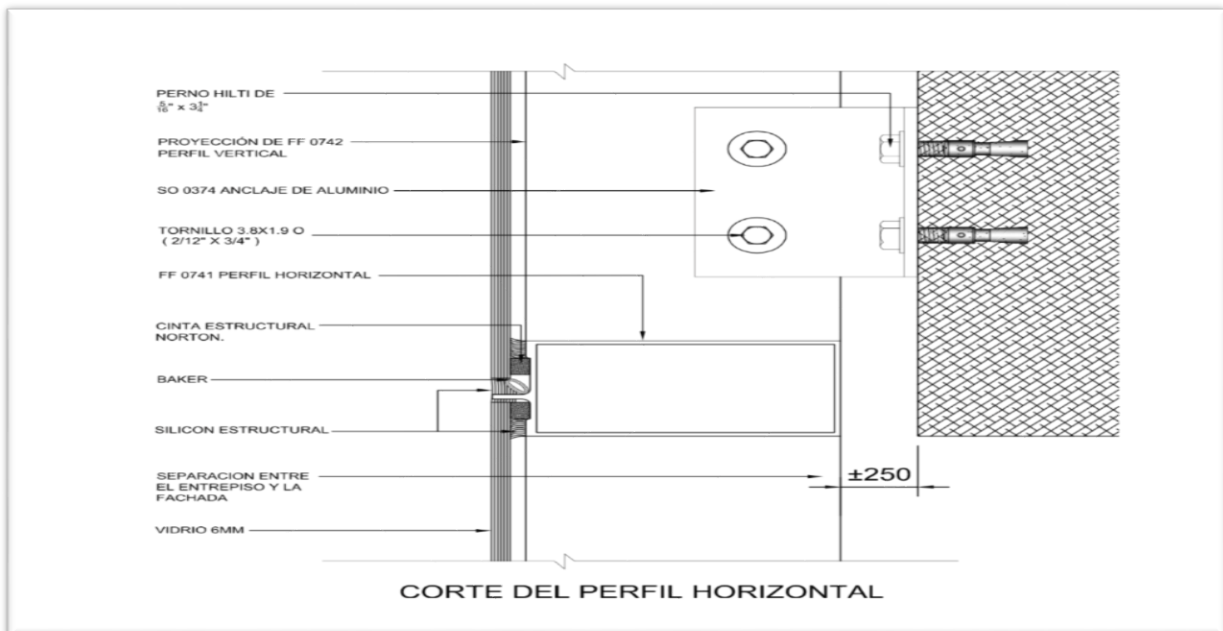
Detalle de anclaje, corte del perfil horizontal. Fuente: (Extralum, 2019)
